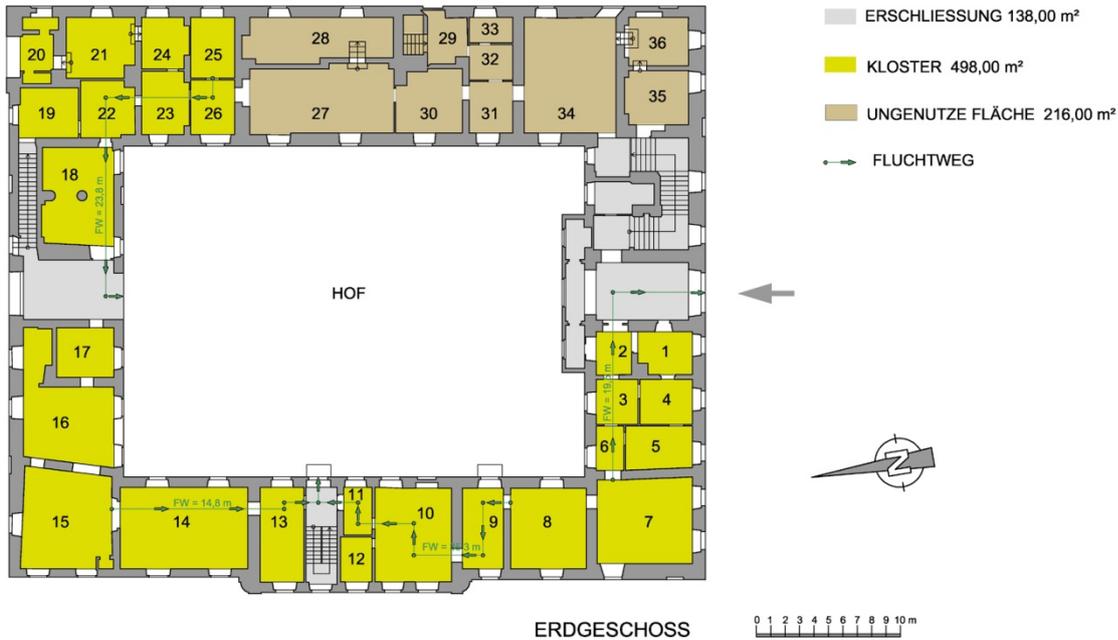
zeigt den Grundriss des Schlosses Obersiebenbrunn
